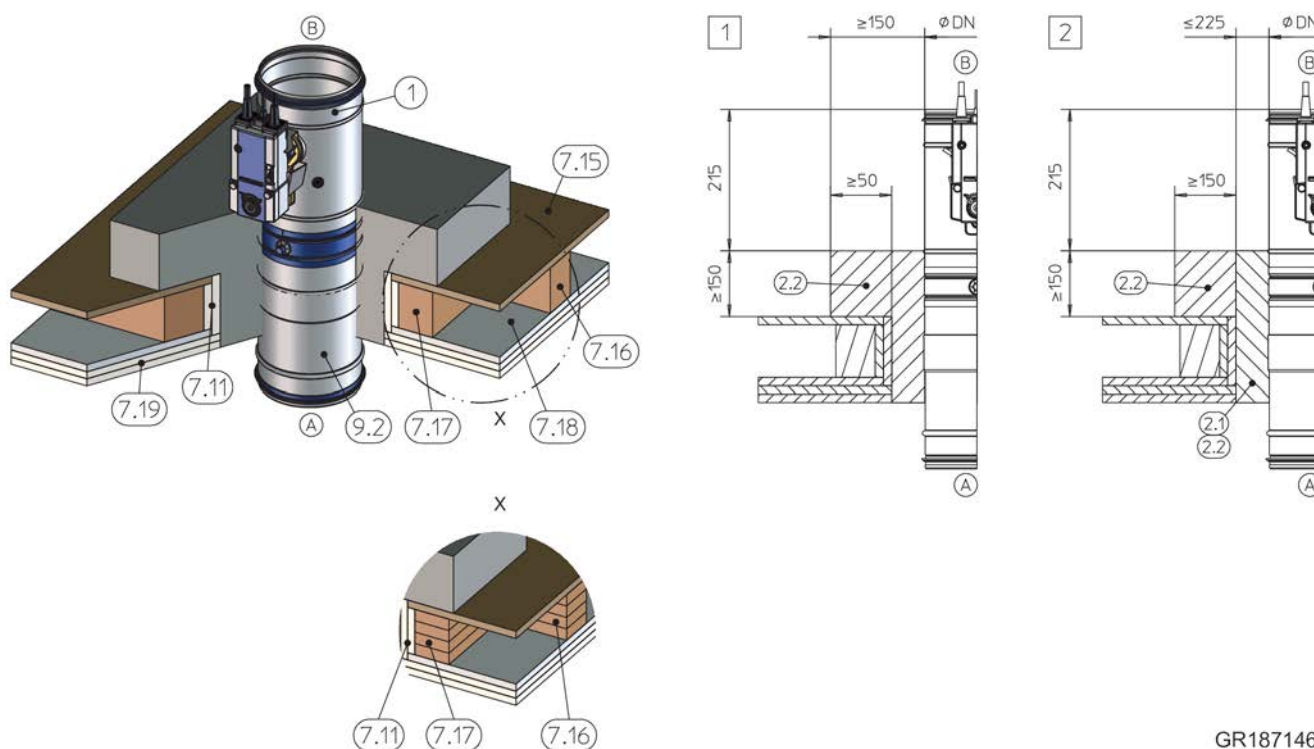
Монтаж с применением строительного раствора в композитных перекрытиях, на рисунке показано вертикальное расположение (также применимо для монтажа на подвесах)
